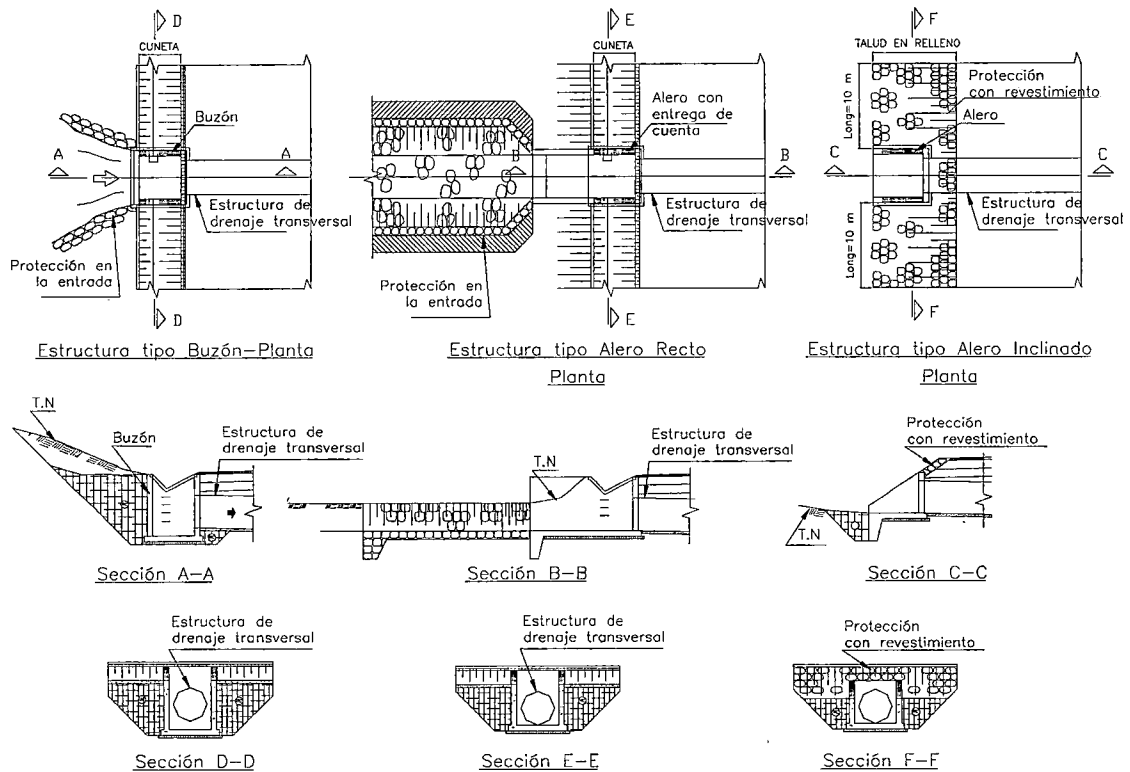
Algunos Tipos de Estructuras de Entrada en la Obra de Drenaje Transversal.
